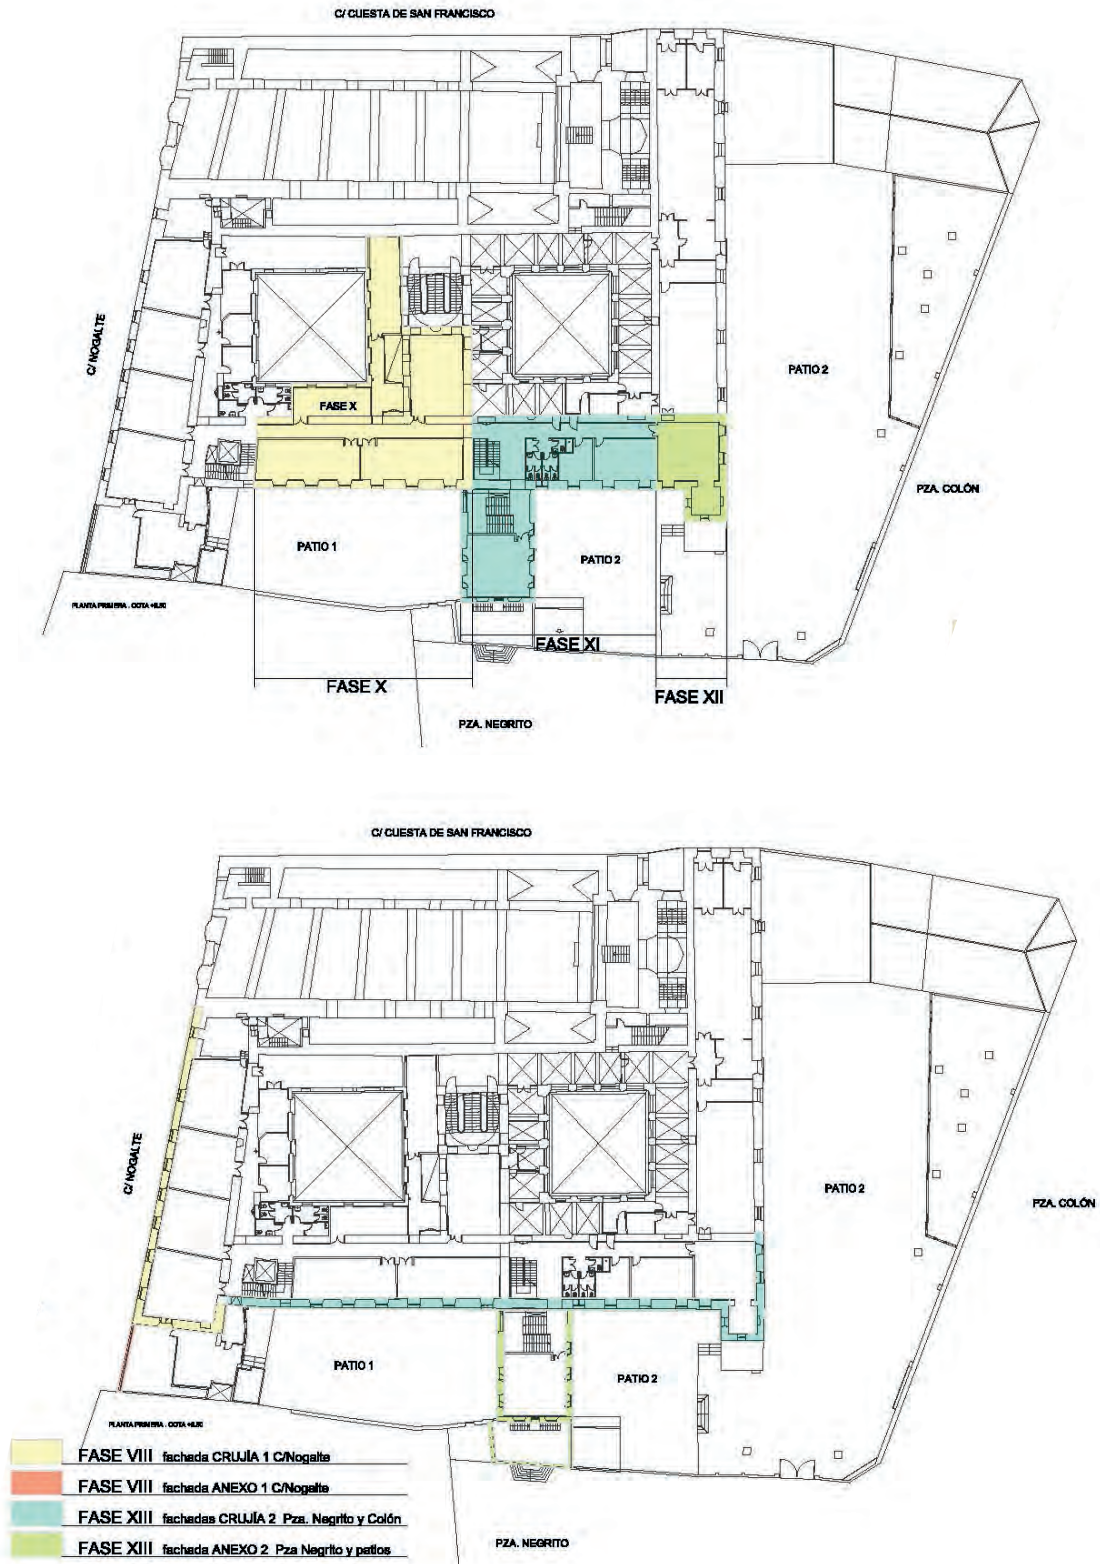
Distribución de las distintas fases de actuación, representadas en la planta del conjunto.
